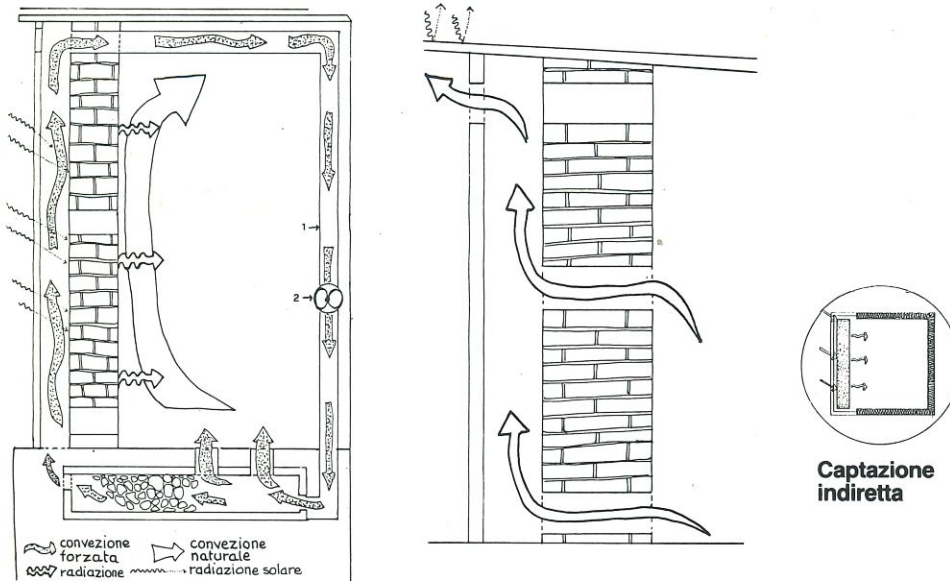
Hunn House - New Mexico. Muro Trombe costruito in adobe.
